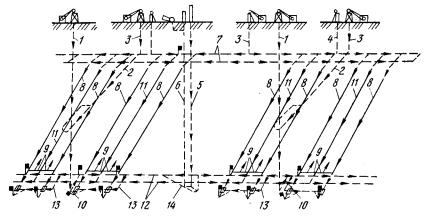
Вариант схемы строительства шахт IV группы при вскрытии и подготовке пласта блоками с разработкой столбами по падению:
